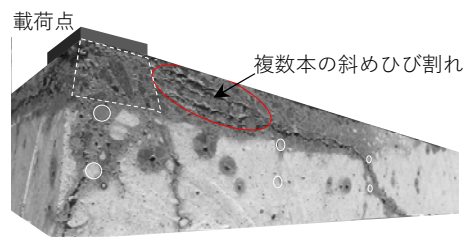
劣化部の荷点近くに生じた複数本の斜めひび割れ³⁾
